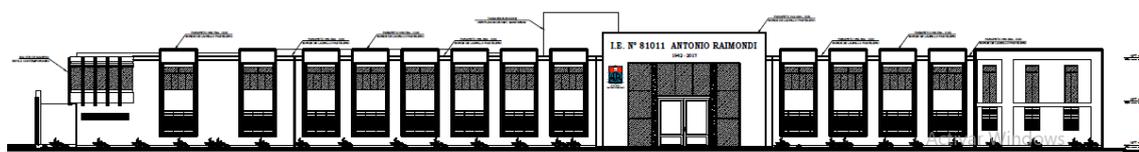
Reconstrucción de la IIEE Antonio Raimondi 2020 - Primer Nivel
